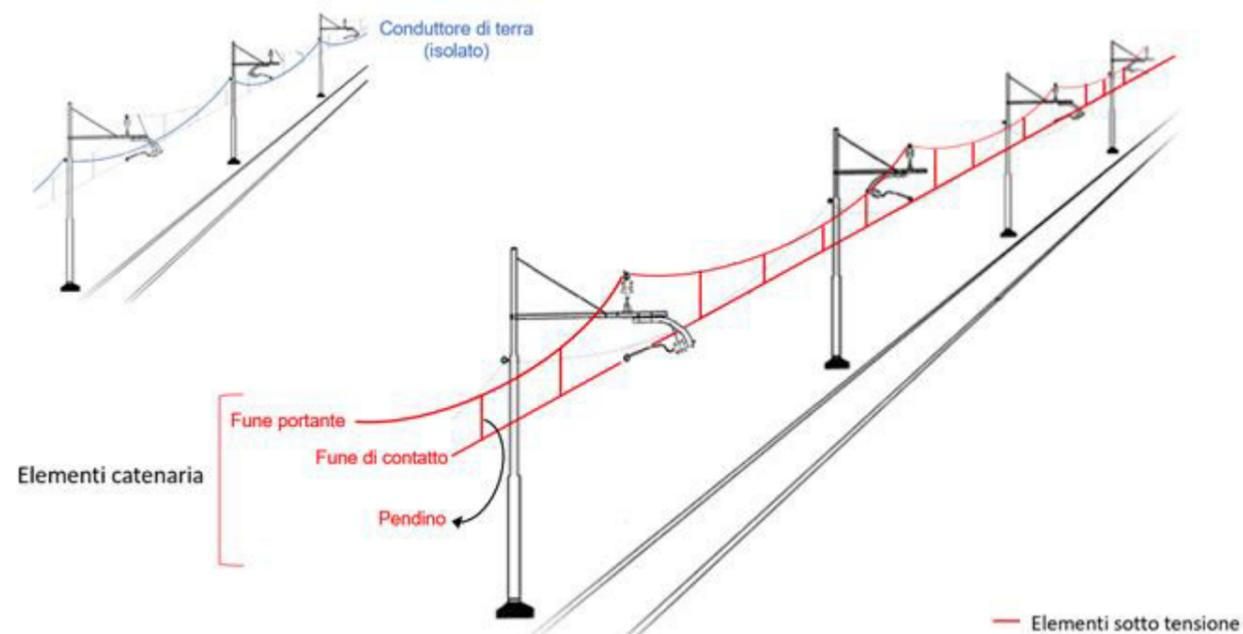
Elementi sotto tensione della componente aerea della linea di trazione elettrica ferroviaria
